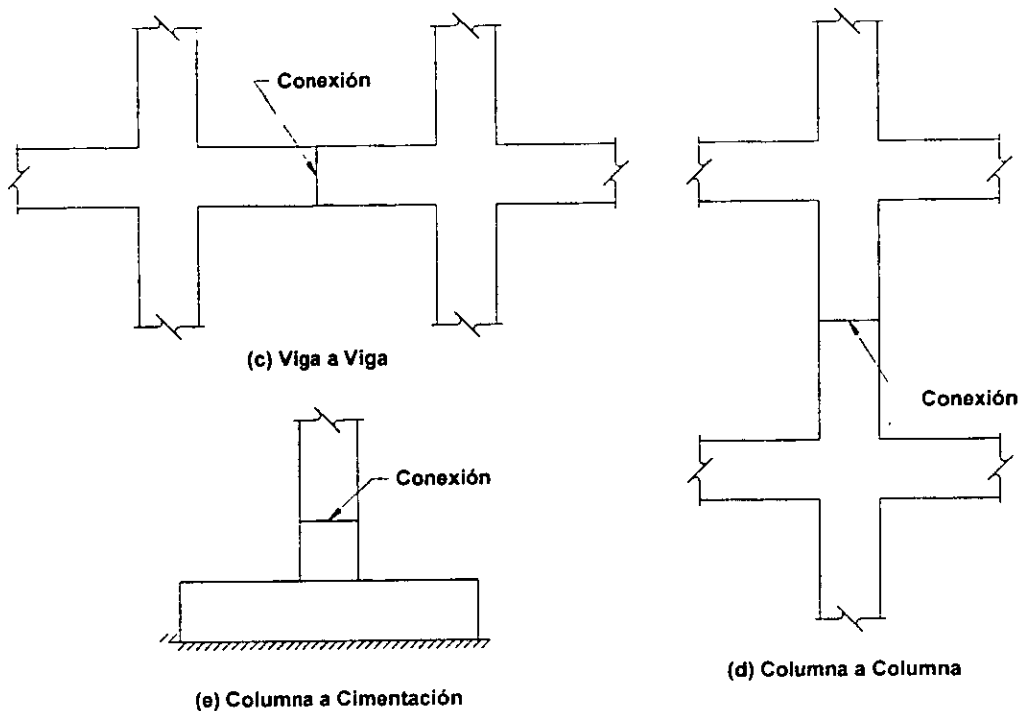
Geometría de conexiones en elementos prefabricados [Ghosh et al., 1997]
